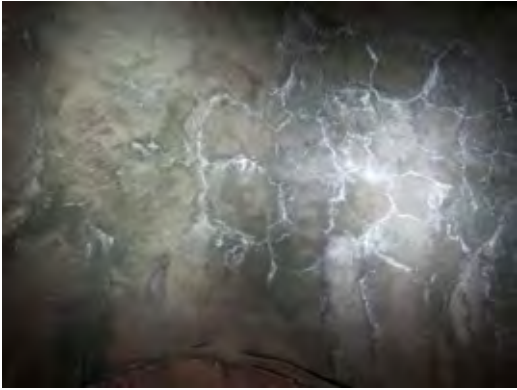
トンネル No.1 吹付けコンクリートひび割れ状況（起点側坑口から 140m付近）
